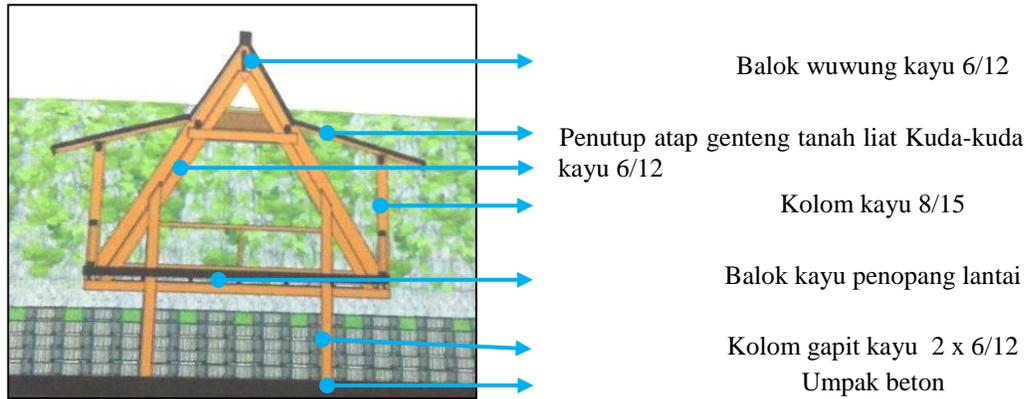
Elemen Penyusun Ruang Segmen 2 Jalan Salib
